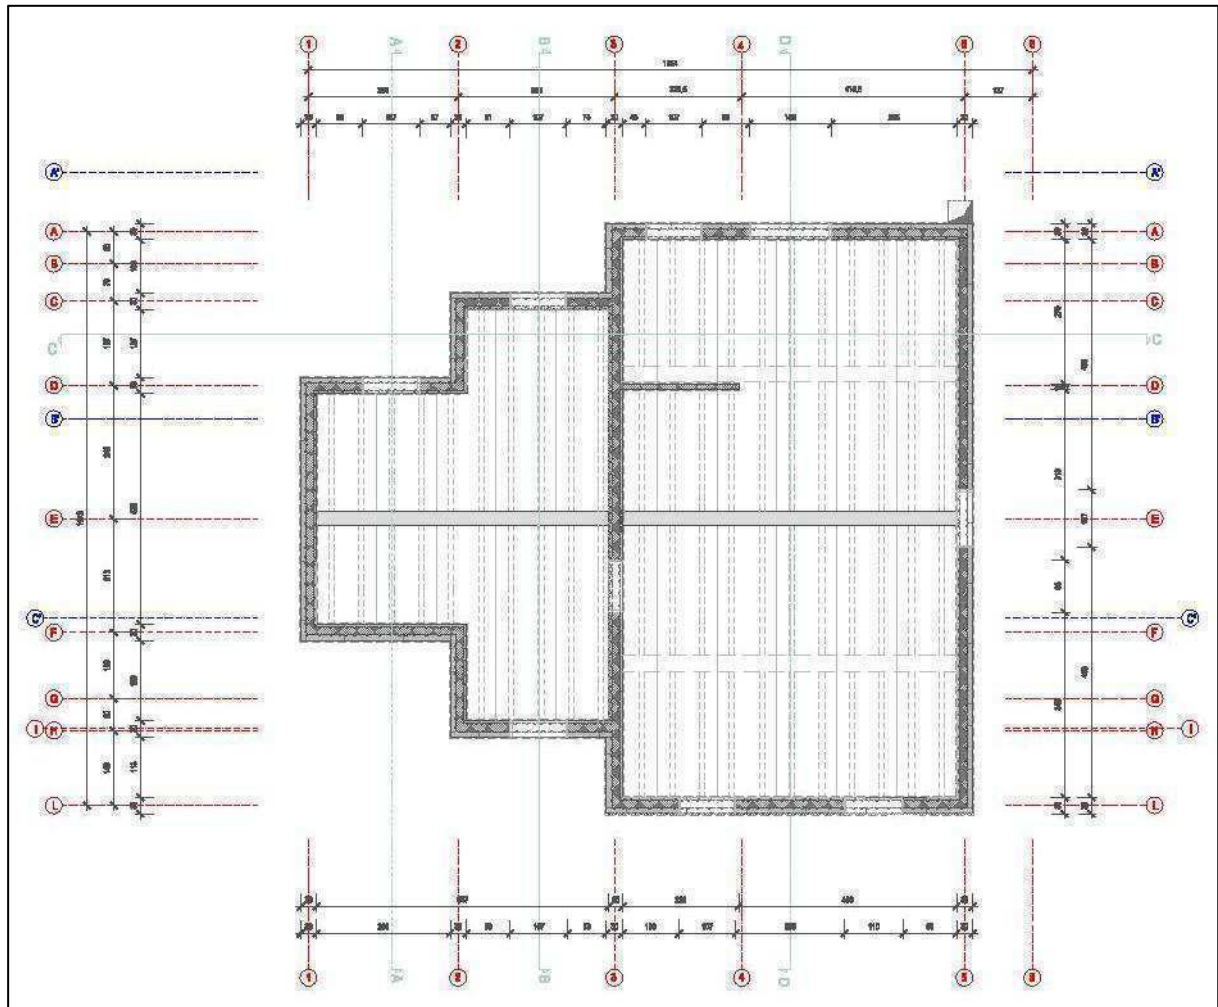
Pianta Piano Primo – Murature – Carpenterie; Tavola 5.
